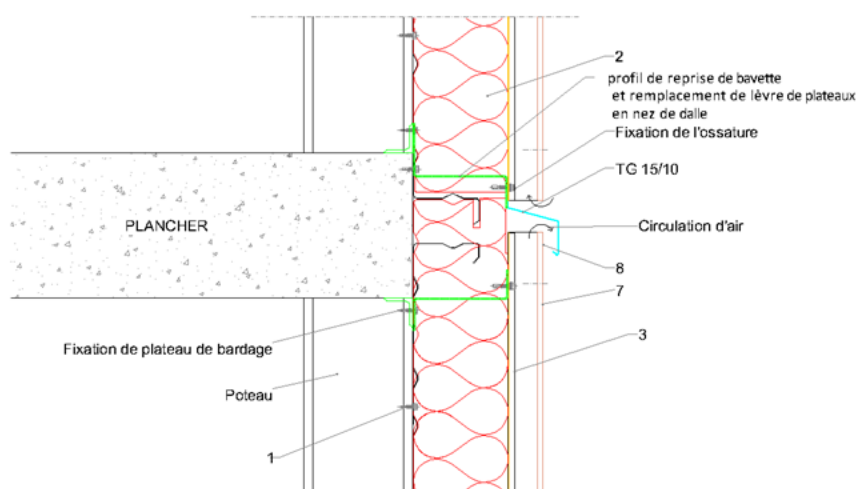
Fractionnement au droit de chaque plancher en zone sismique – Coupe verticale
